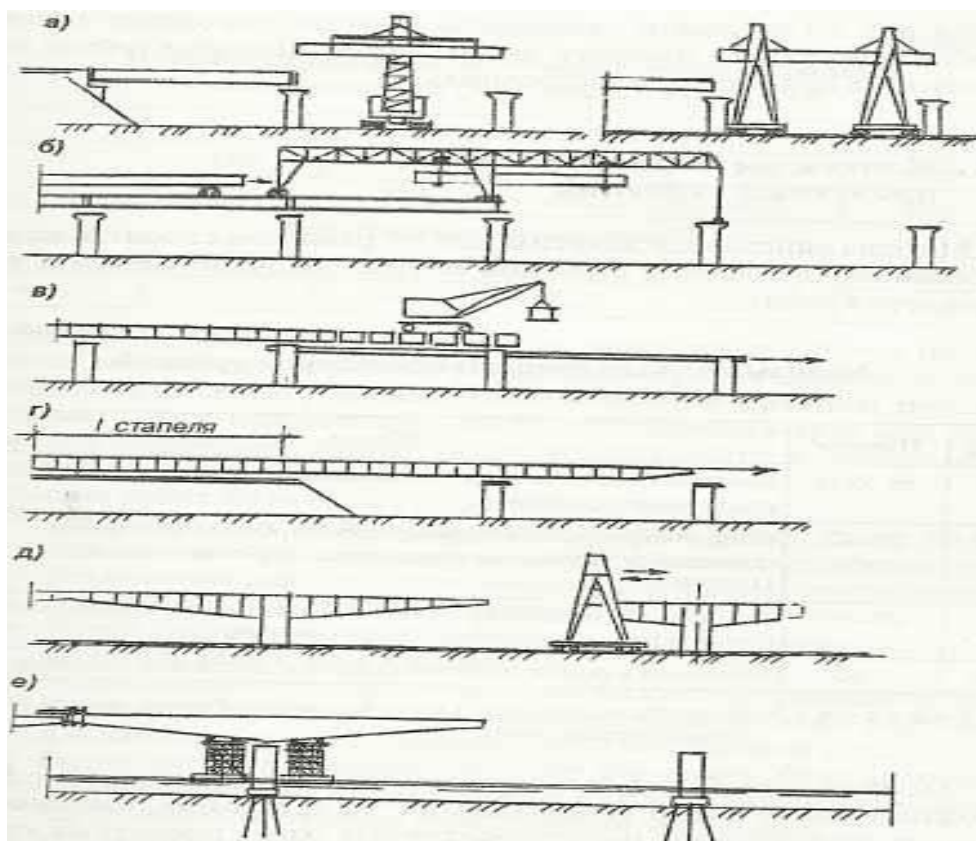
Технологии монтажа пролетных строений из сборного железобетона: а – монтаж балок с земли; б – монтаж балок сосмонтированного пролетного строения; в – монтаж неразрезных балок на перемещающихся подмостях;
